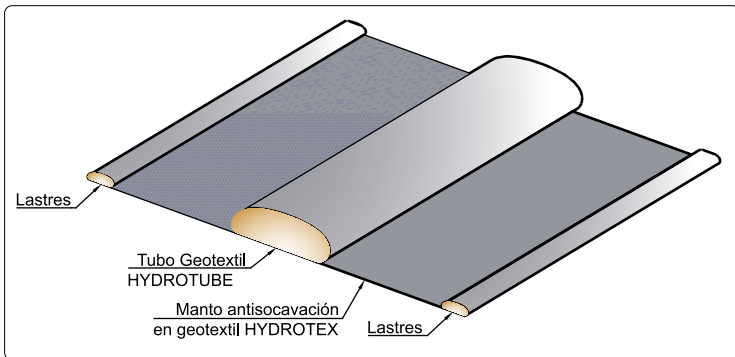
Sección transversal típica de un tubo geotextil Hydrotube
